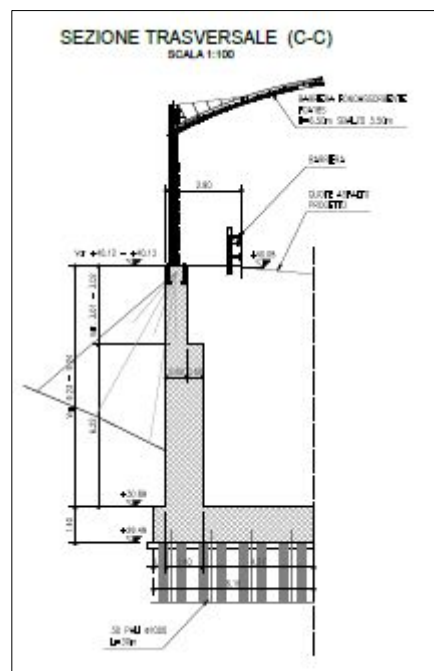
Sezione trasversale (in corrispondenza spalla)
